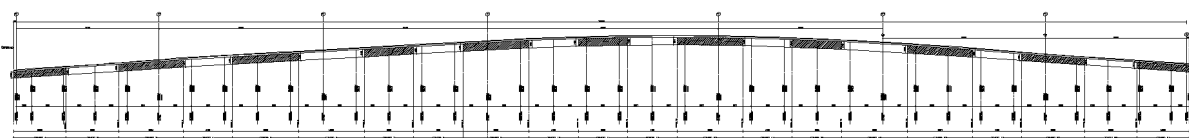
Sovrappasso di ingresso – sezione longitudinale trave esterno curva
